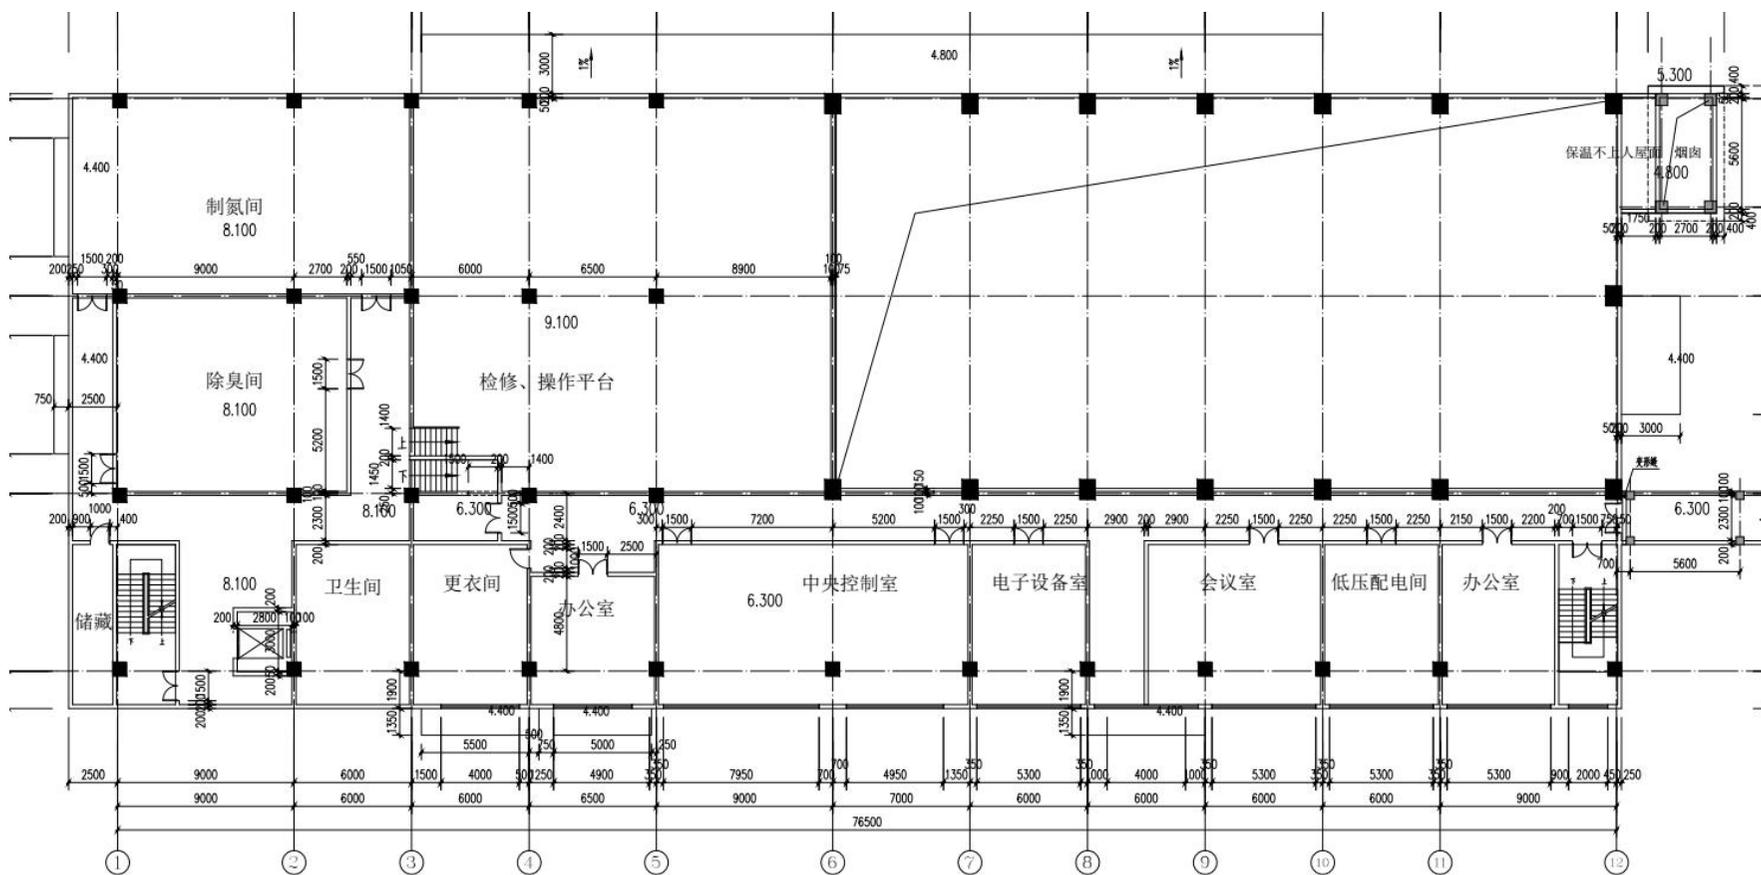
项目主厂房二层平面布置图 (1:150)
